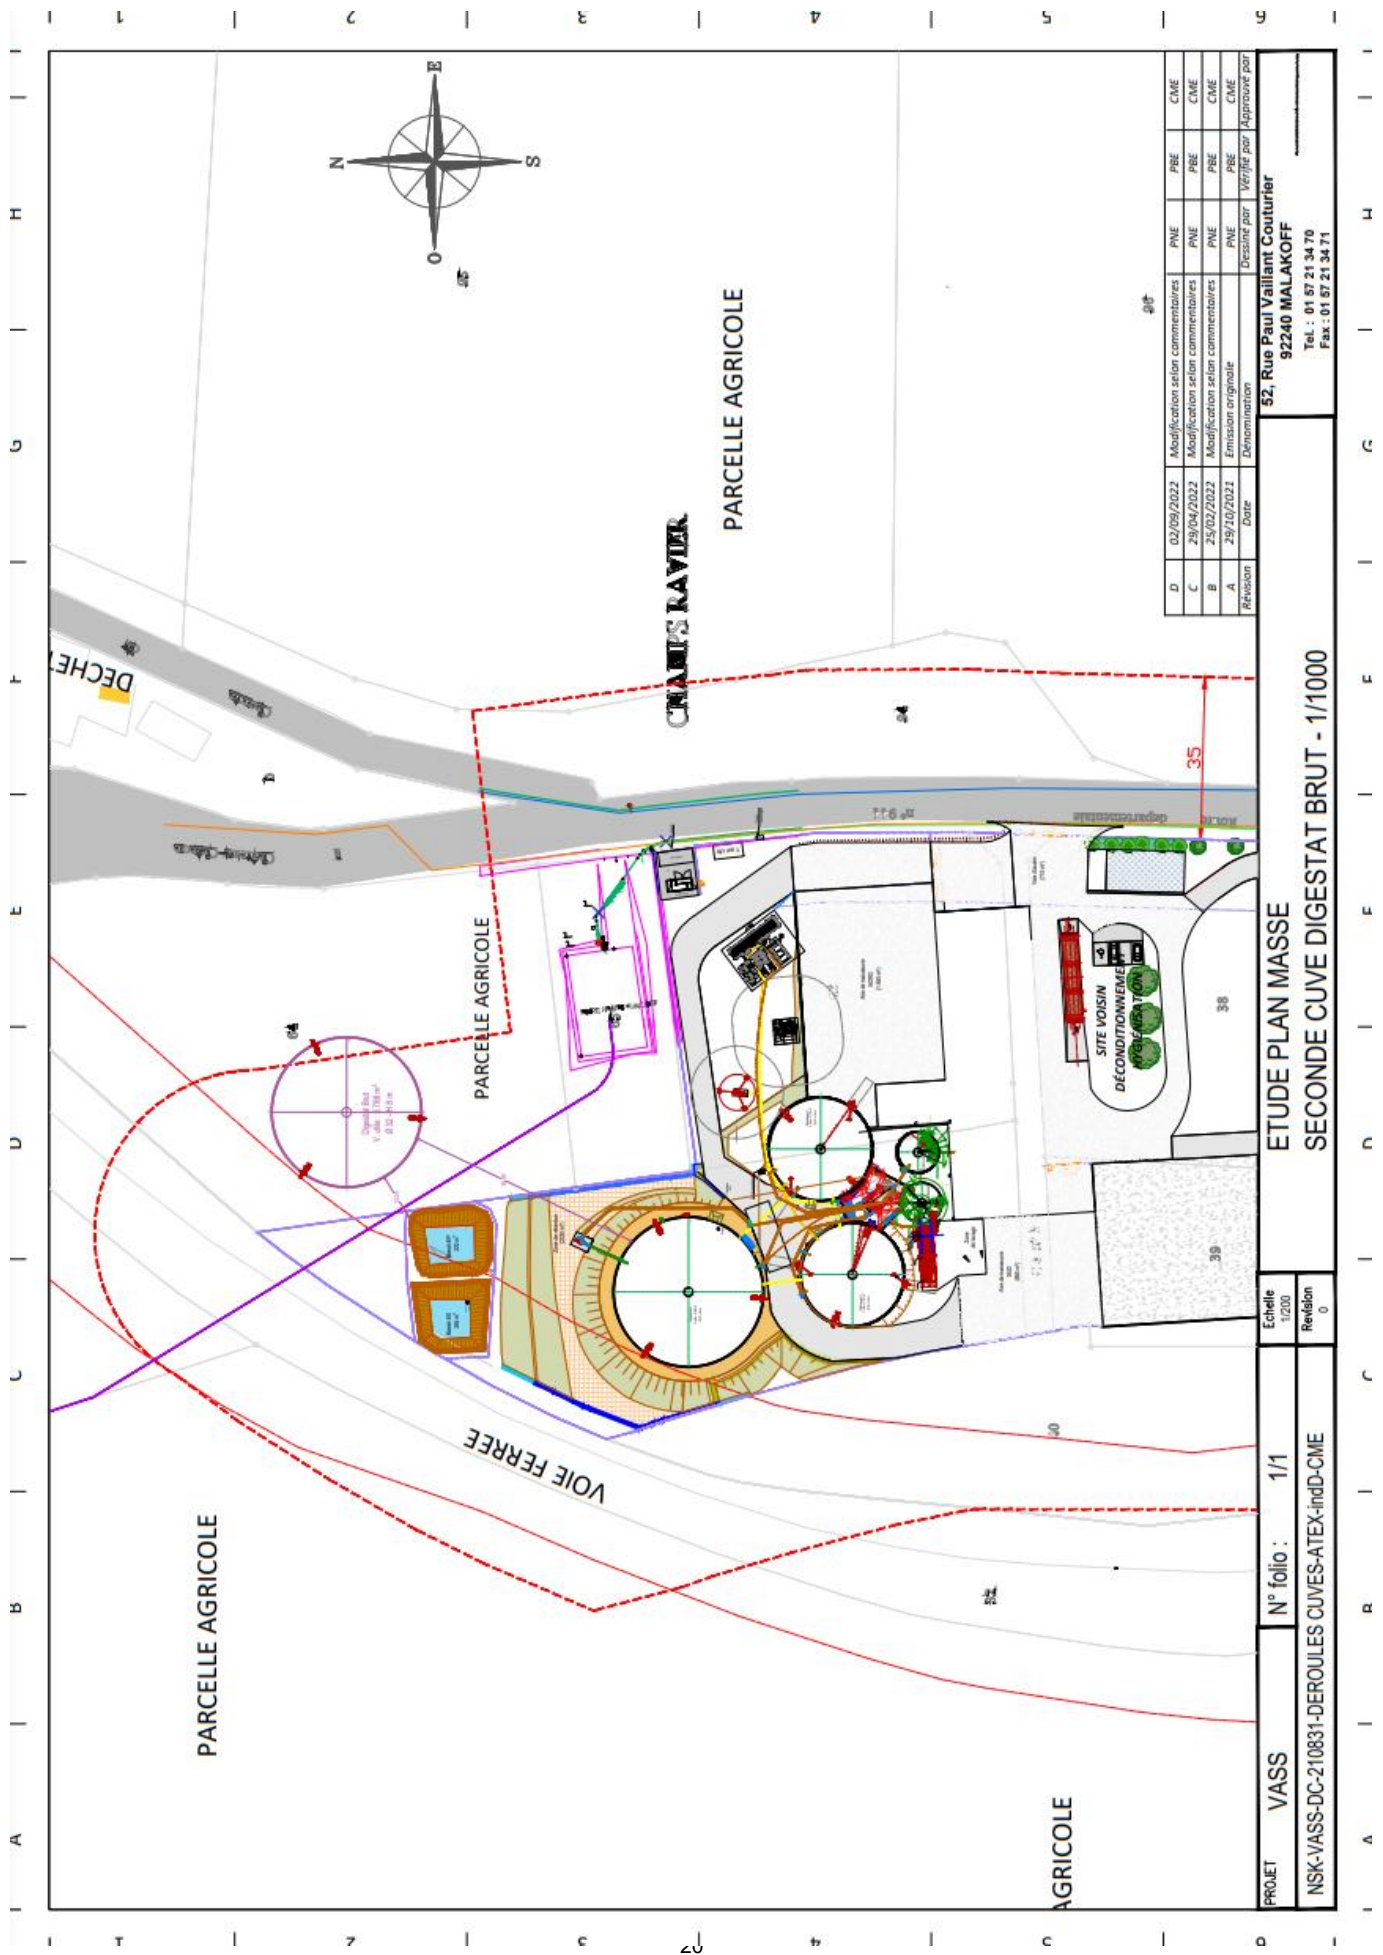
Extrait du plan de zonage « Etaule – ZA du Champ Ravier »
